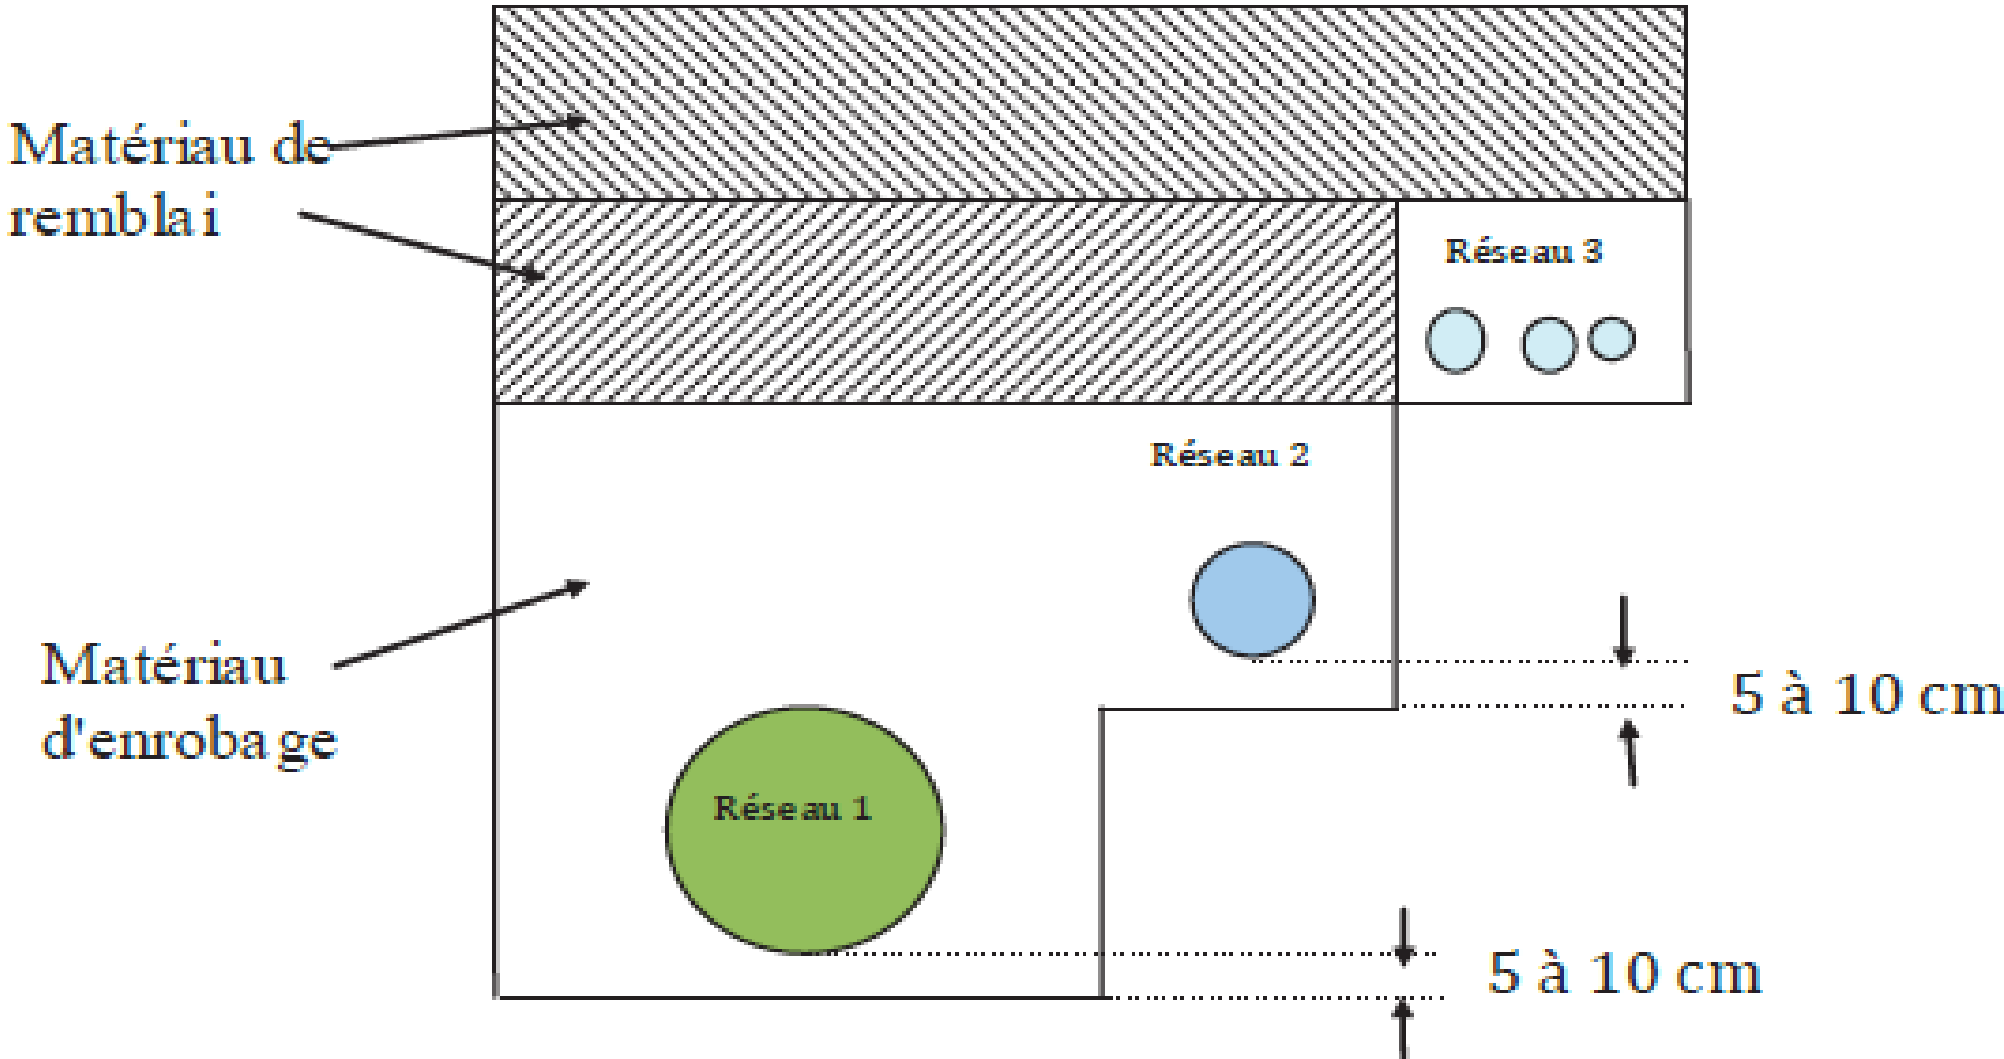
Exemple de coupe de tranchée multi-réseaux
